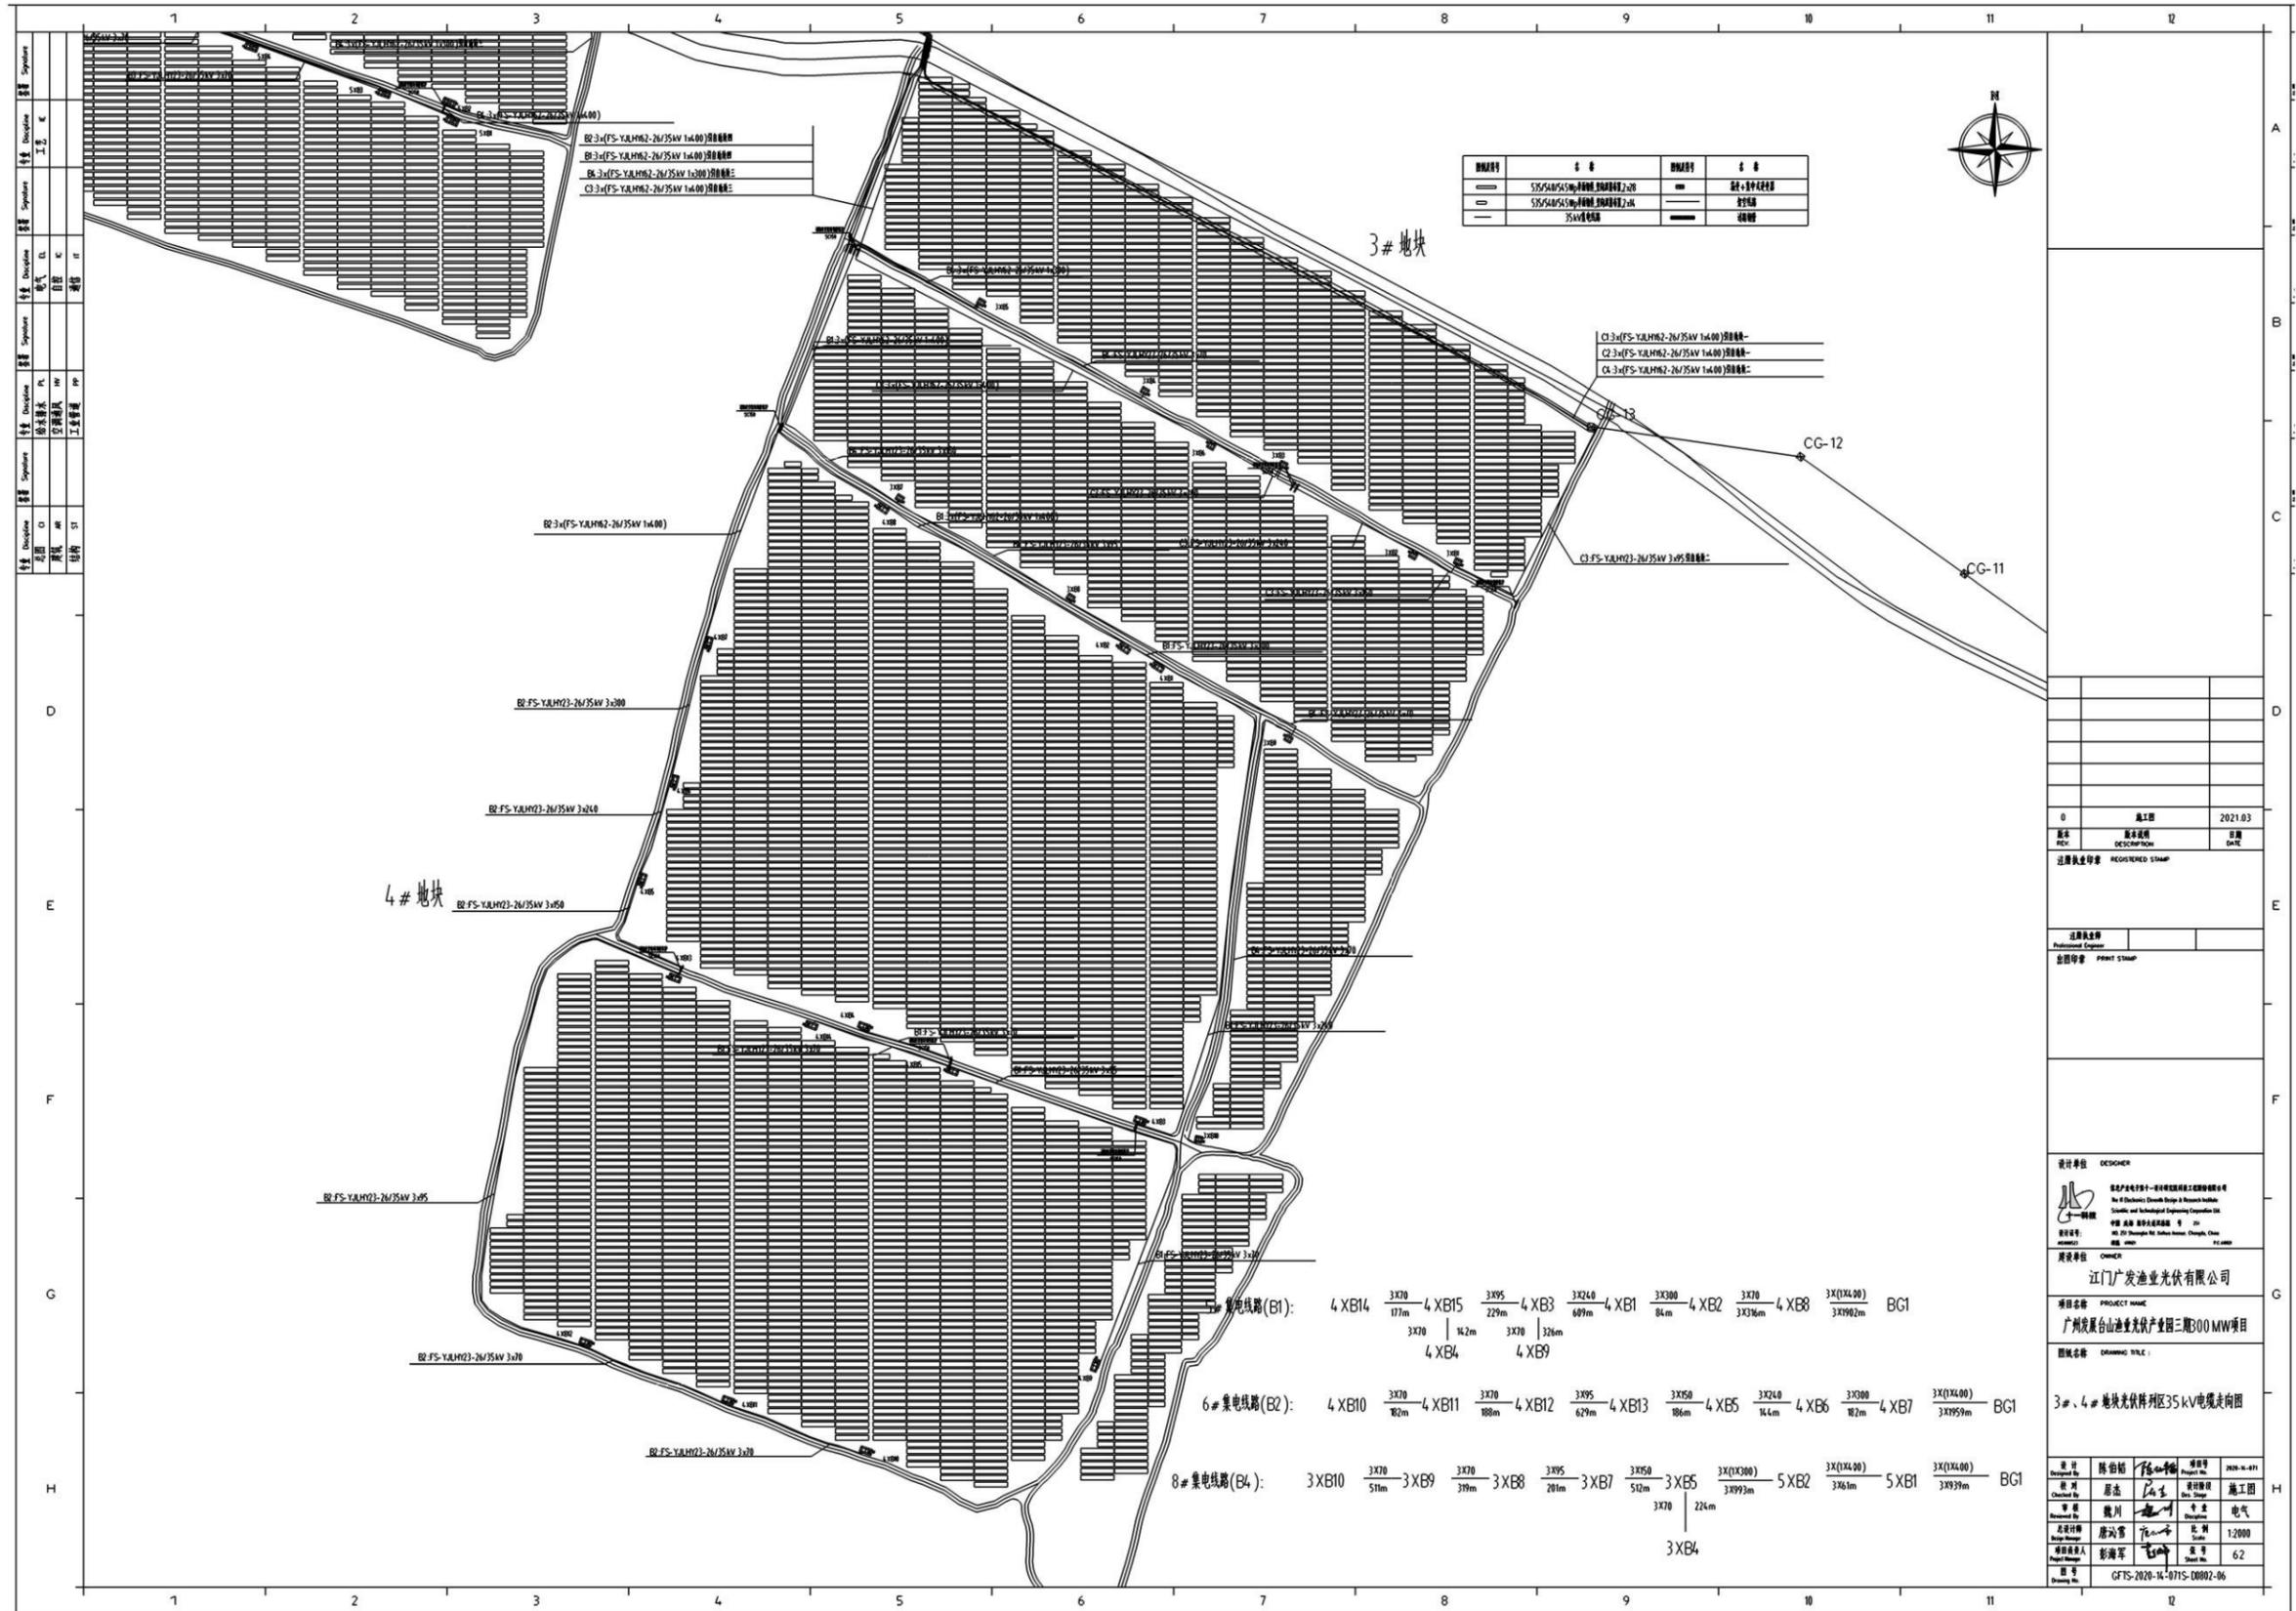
光伏区平面布置图 (A5-A10)
